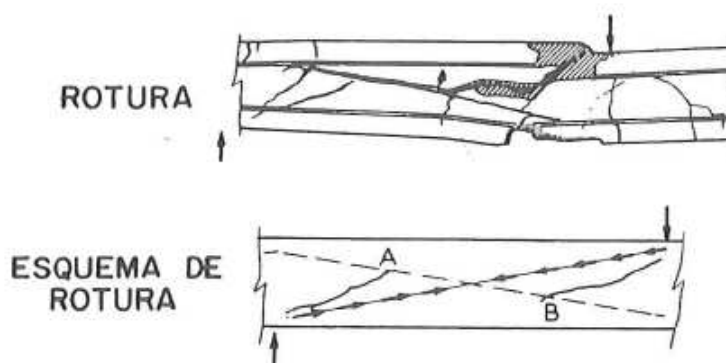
b Rotura y esquema de rotura en vigas continuas en doble "T" pretensadas (Sozen)
